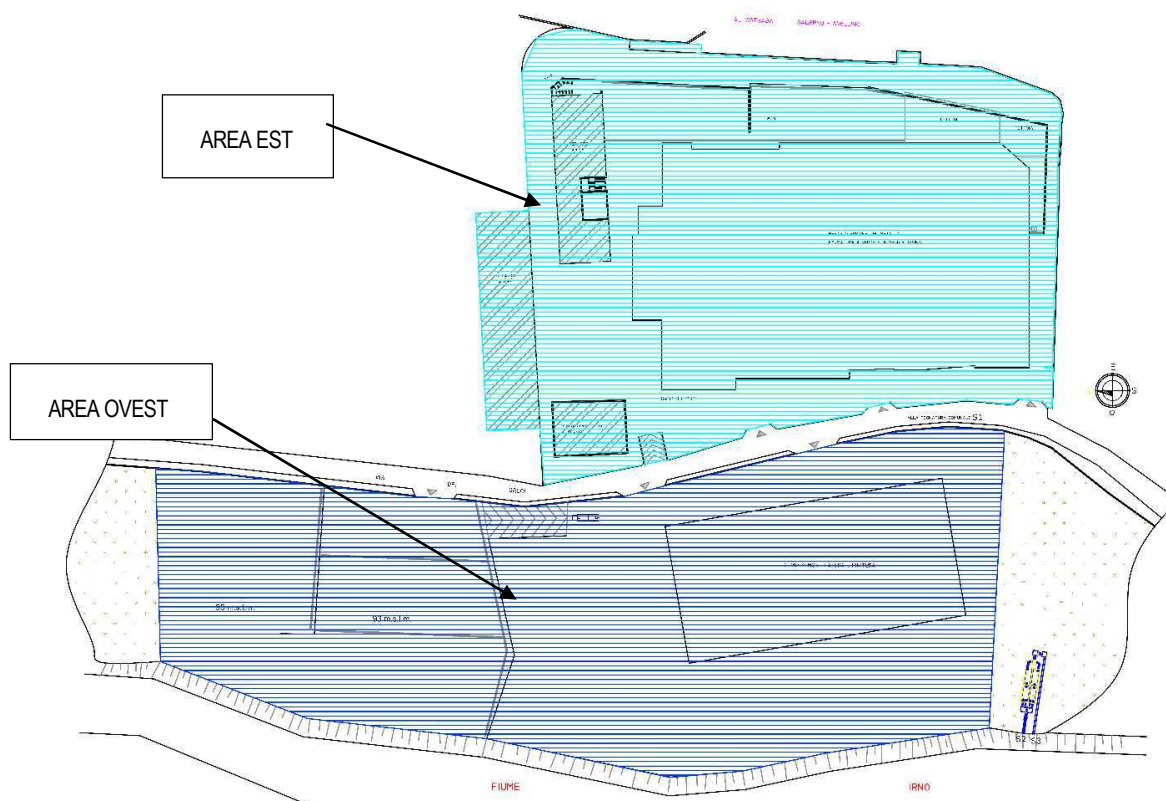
Stralcio planimetrico con indicazione delle superfici scolanti – Stato attuale
